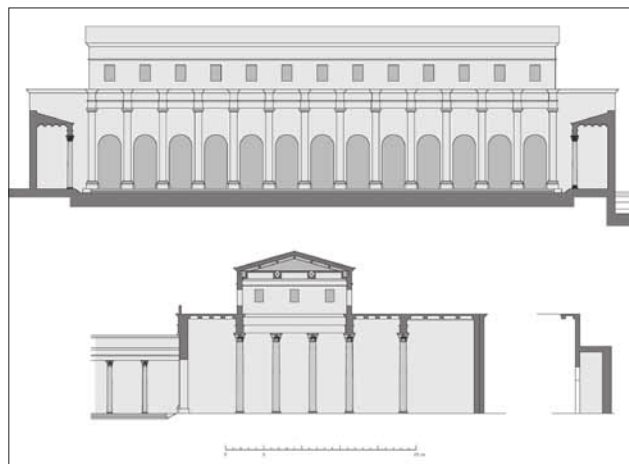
Restitución de la fachada de la basílica jurídica hacia la plaza forense y sección transversal por el eje axial. La presencia de bloques de pilastras entre las ruinas del edificio permite plantear que la fachada tuviera un sistema de puertas y no una doble columnata.
